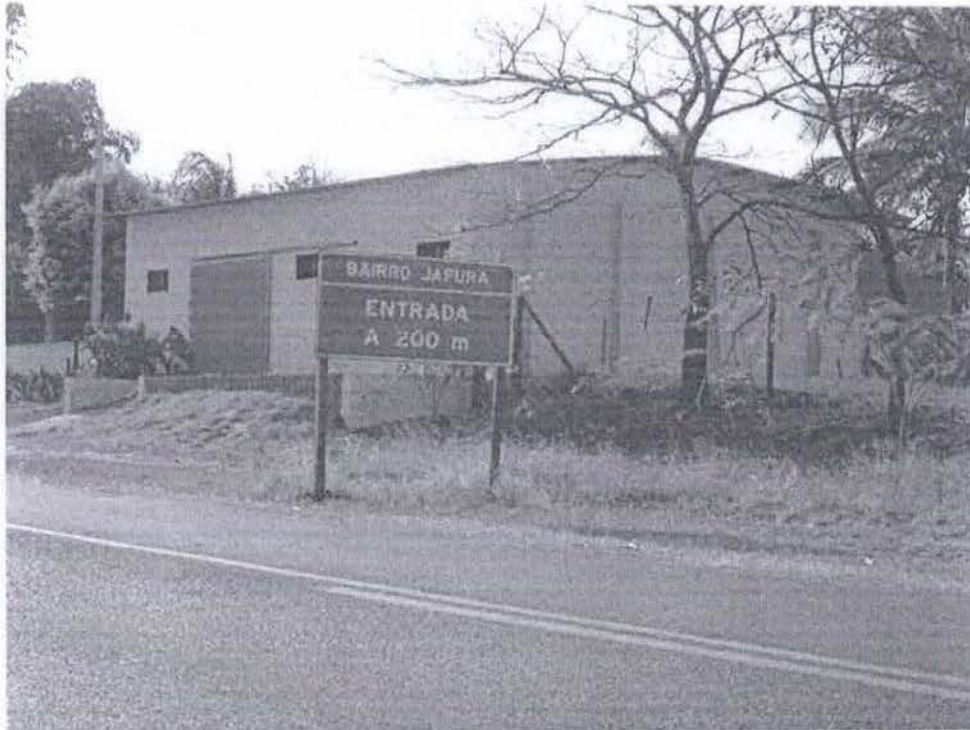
Vista da entrada para Estrada Vicinal Tabapuã/Uchôa com placa indicando o acesso para o bairro Japurá.
